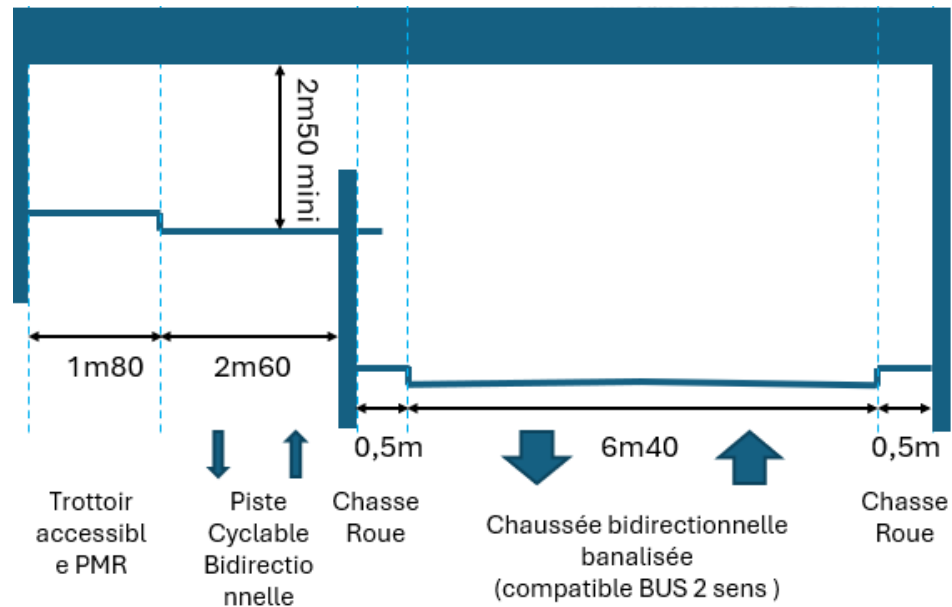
Coupe de principe de l'ouvrage Cauvet (Source : SETEC)
